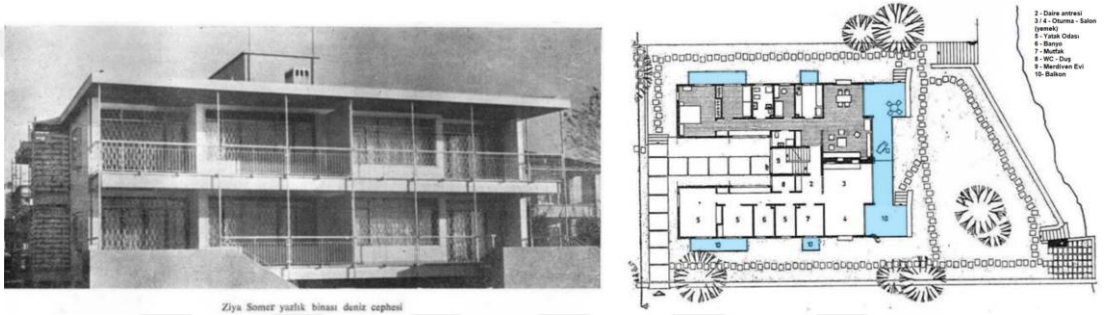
Projenin Vaziyet Planı ve Kat Planı
